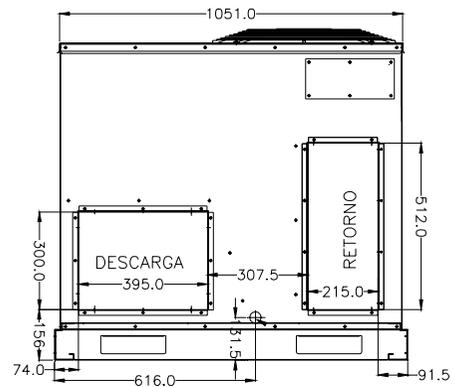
Aberturas para Conducto de Inyección y Retorno Horizontal
